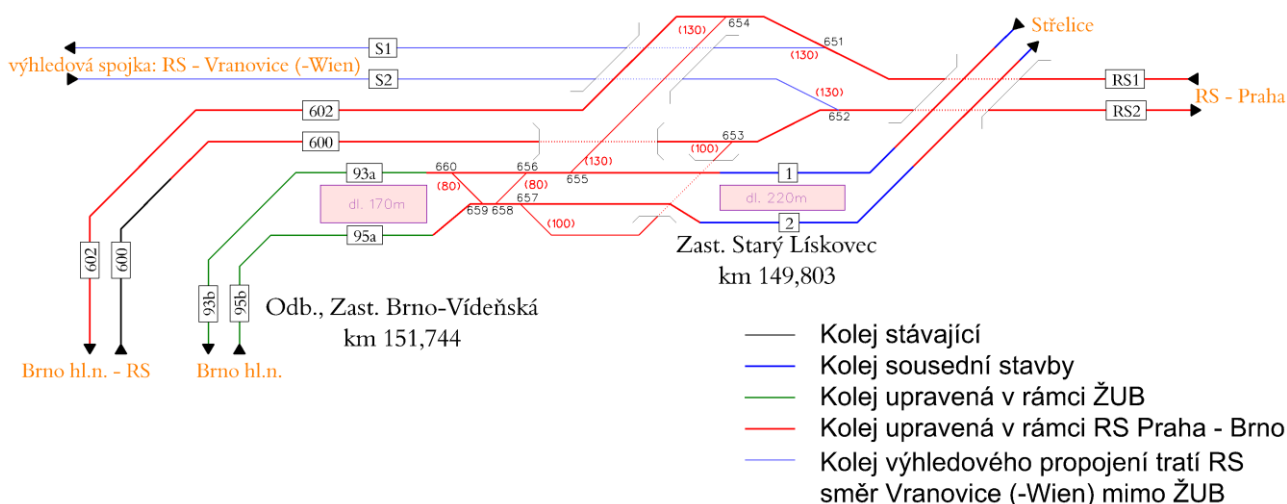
Zapojení tratě Brno – Střelice a RS Praha - Brno, původní řešení
